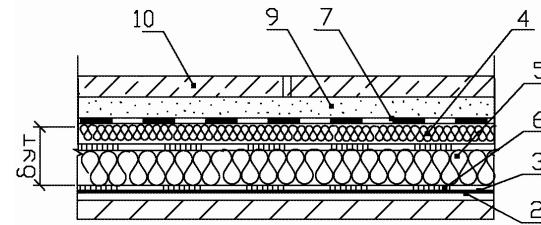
Покрытие по железобетонным плитам с теплоизоляцией из плит ИЗОРОК в два слоя с приклейкой битумными мастиками.
